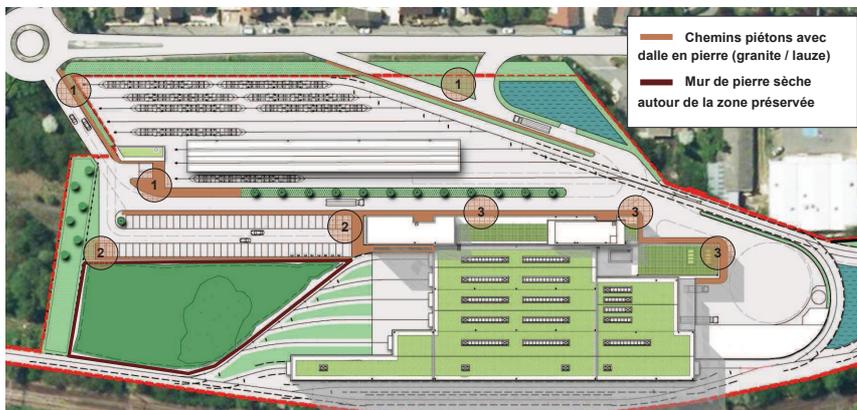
Localisation des chemins piétons avec des dalles de pierre et du mur de pierres sèches autour de la zone préservée (Source : AREP, 2013)
